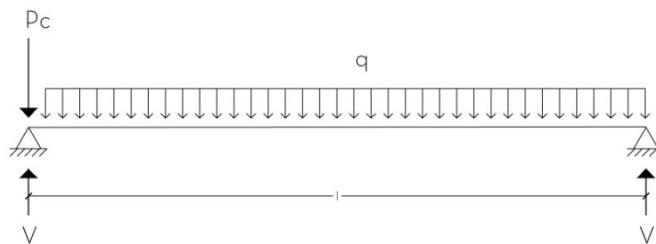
, Schema statico trave balcone. Fonte autore tesi
